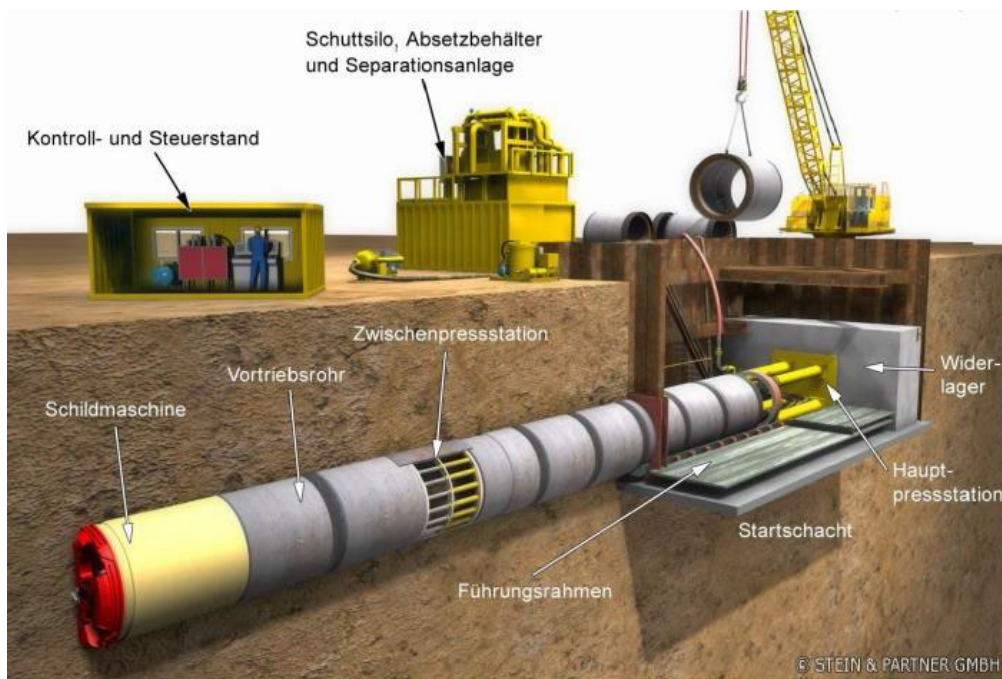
Geschlossene Bauweise für eine Erkkabelverlegung (Kabeltunnel), Quelle: Herrenknecht AG
